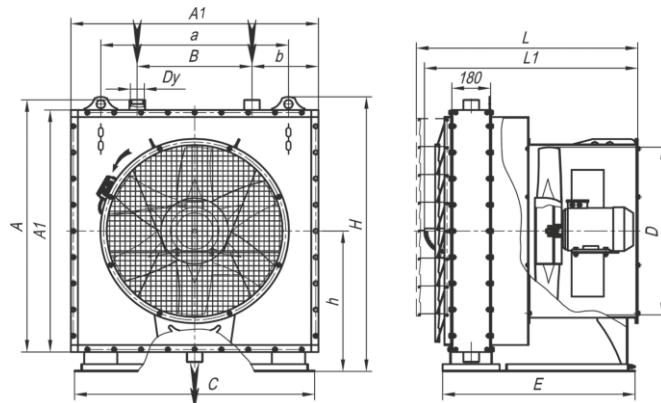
Габаритные и присоединительные размеры агрегатов АО 10-25П на базе воздухонагревателя типа КП.
